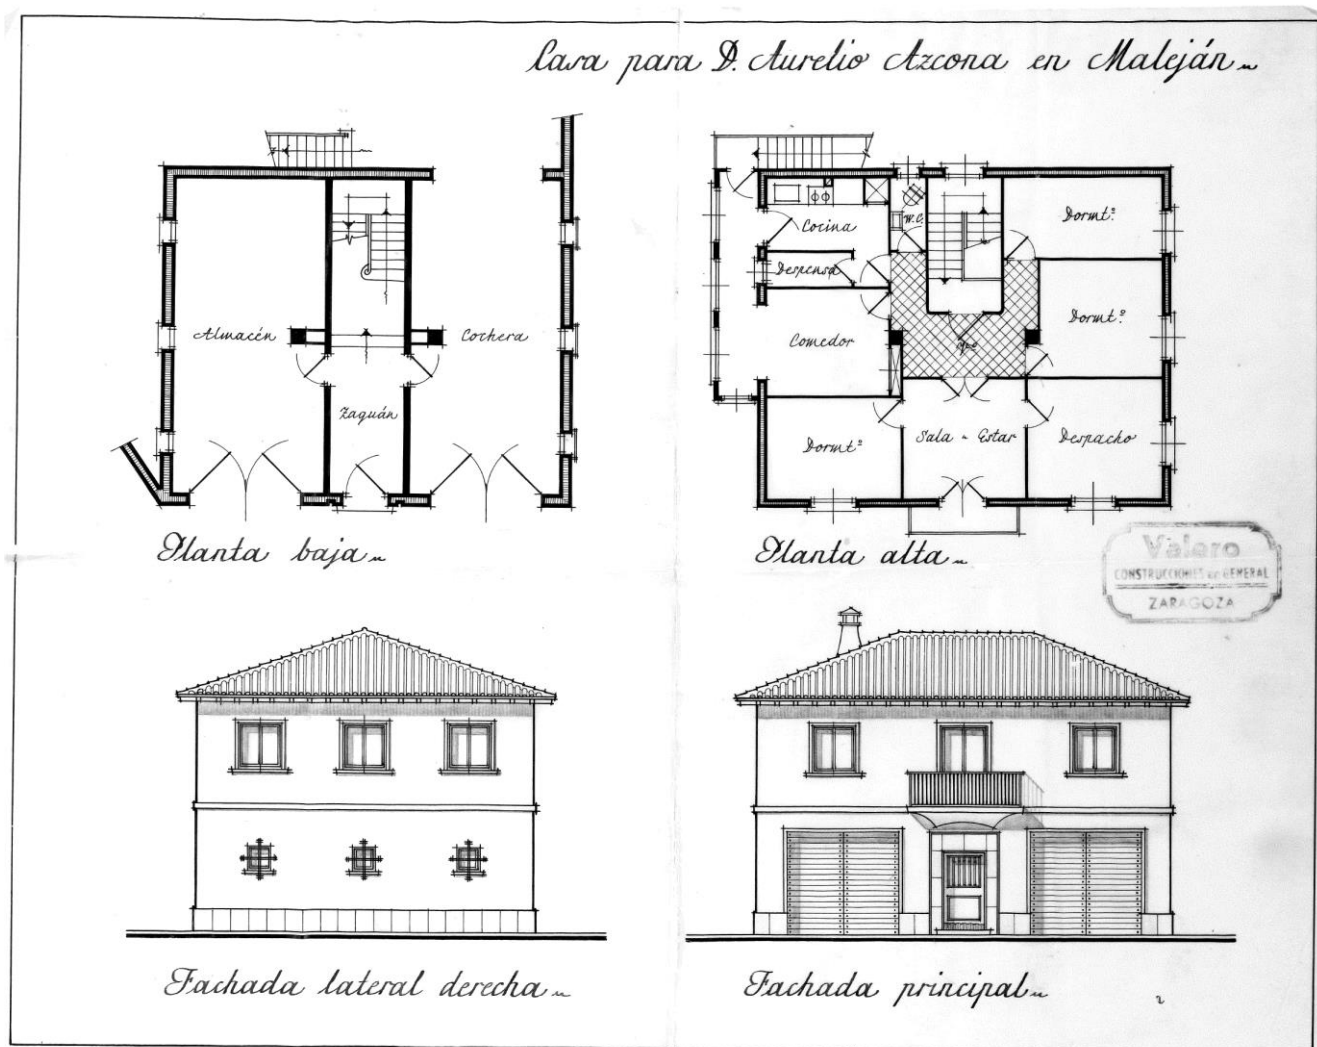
Plano de construcción de la vivienda caso de estudio. Fuente: Propietarios de la vivienda.
